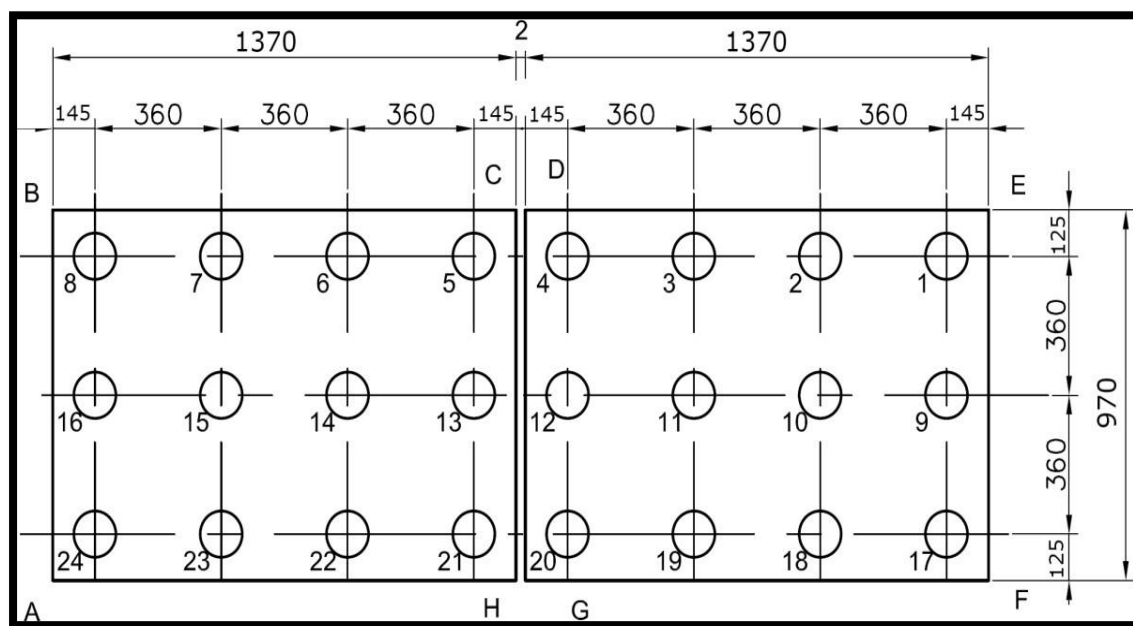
Plan de disposition des pieux dans les deux semelles de la culée.
